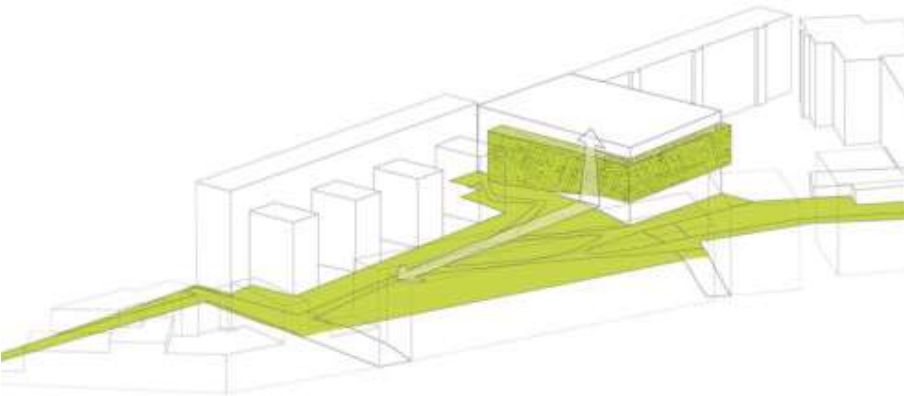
Diagrama explicativo de la conexión visual de la fachada con la zona verde.
